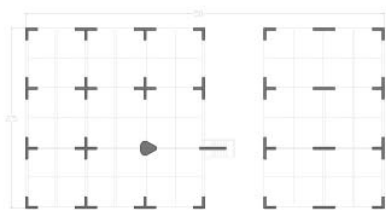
Planta de estructura con la tipología de muros pantalla. Fuente: MCHS.
